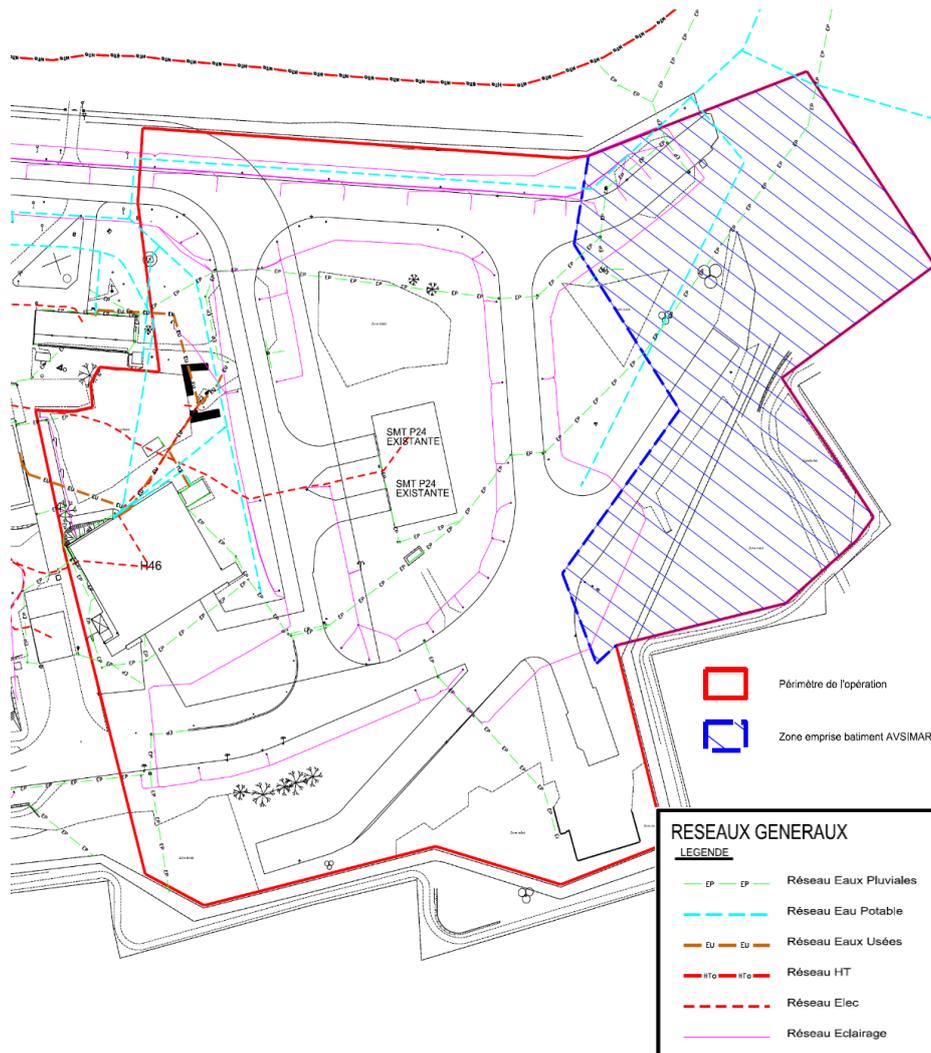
Plan des réseaux existants sur le site du projet – Source ESID de Brest
